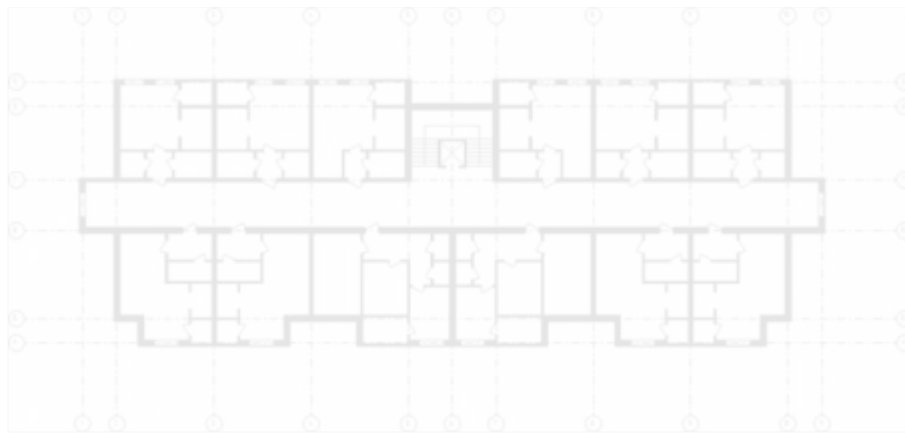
План 1 – го поверху будівлі 3 – го типу
